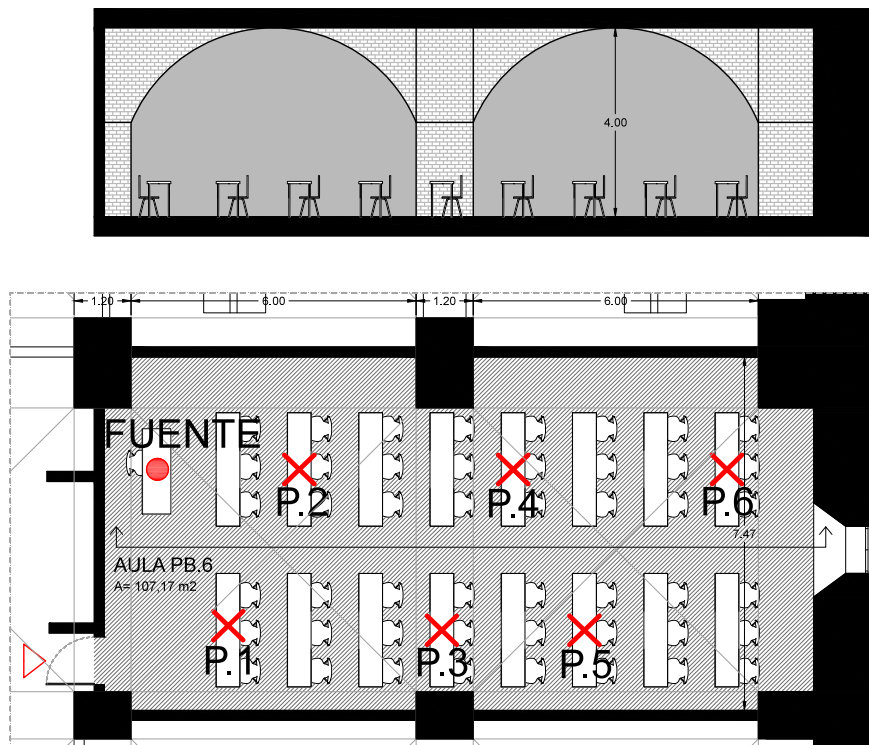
Planta y alzado del aula PB.6 de la ETSIT.
